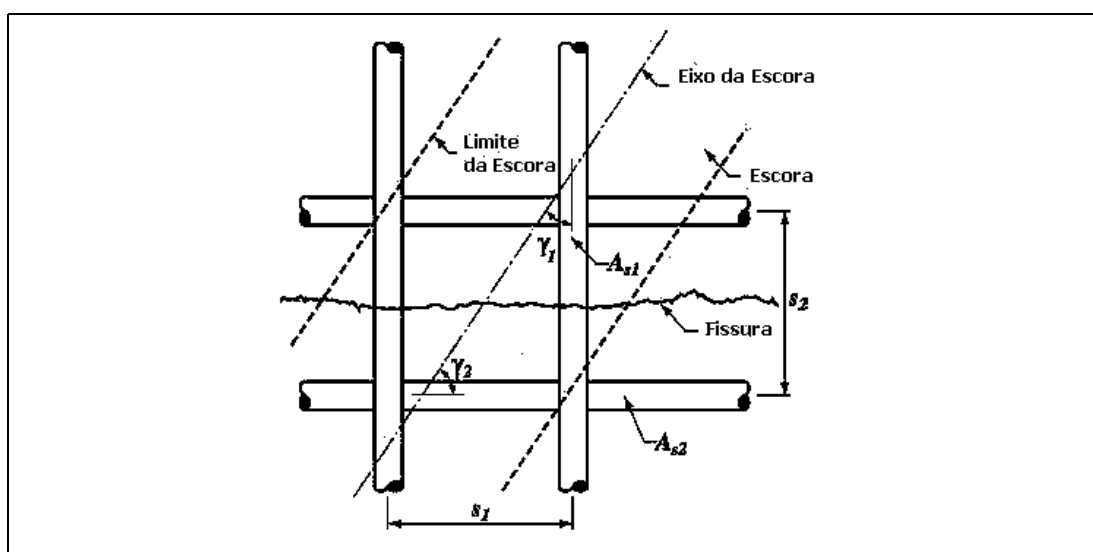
Distribuição de armadura em malha em escoras do tipo garrafa
